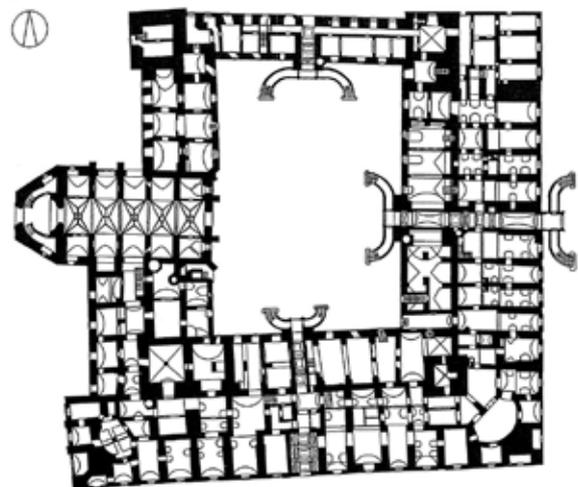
Residenzburg, Grundriss Erdgeschoß (F. Sagaischek)
